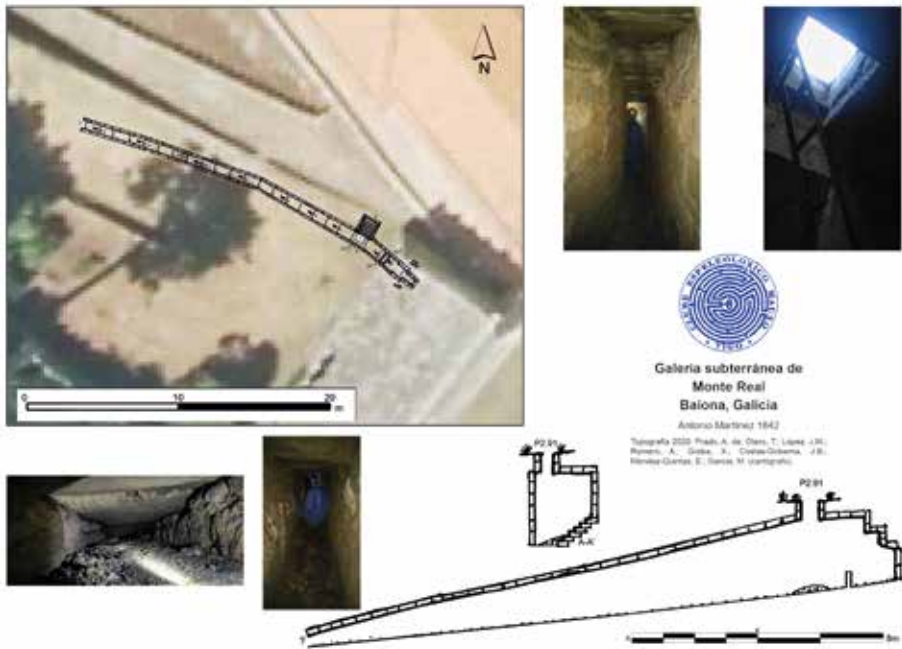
Topografía, planta e alzado, da galería subterránea de Monte Real. Fonte CEM.
